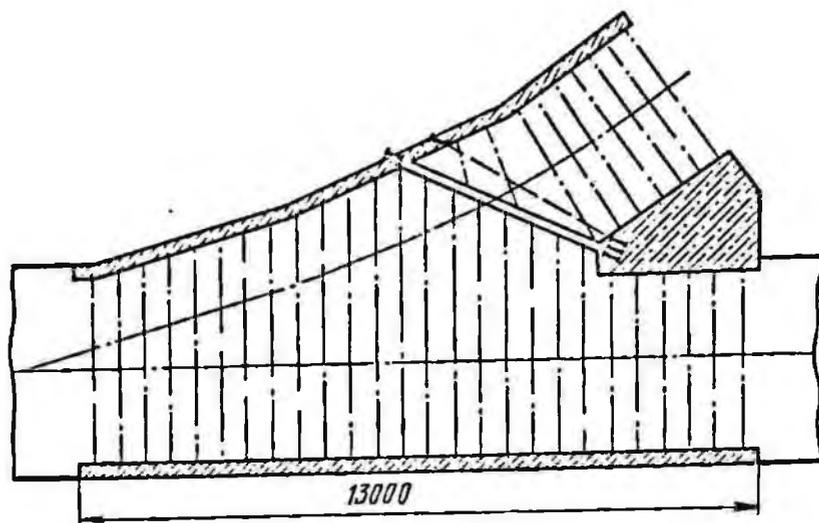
Схема проведения сопряжения однопутных выработок на шахте «Прогресс»
